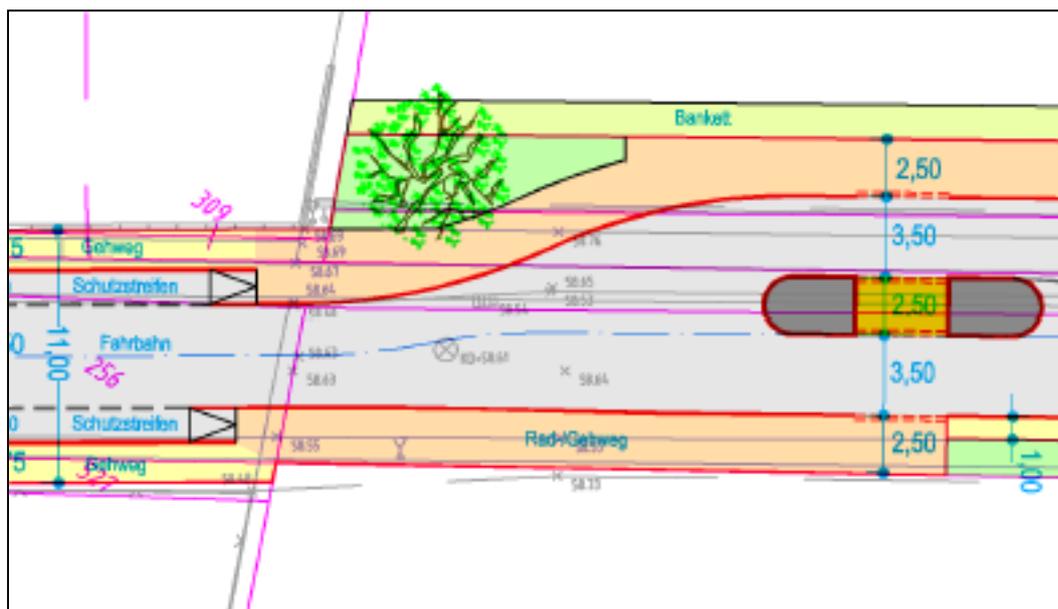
Planausschnitt Apostelpfad (Anschluss Zweirichtungsradweg)
